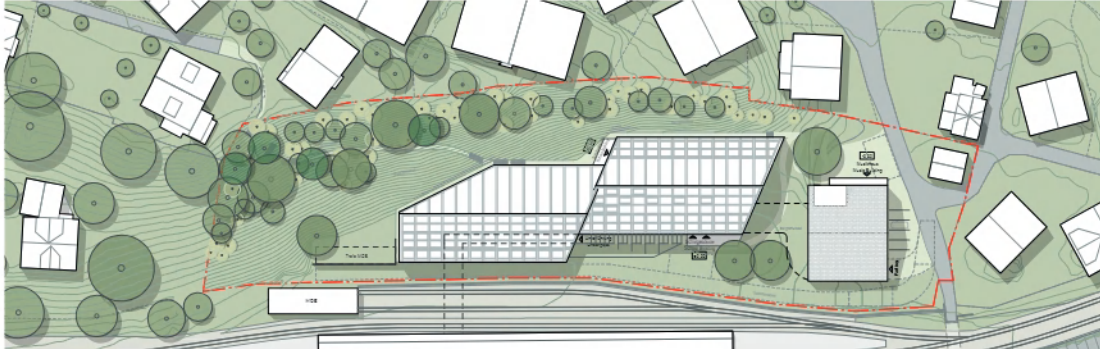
Ausschnitt Situationsplan Dachaufsicht mit Umgebungsgestaltung, Stand: Juni 2023 (Quelle: Snøhetta/Jaggi)
